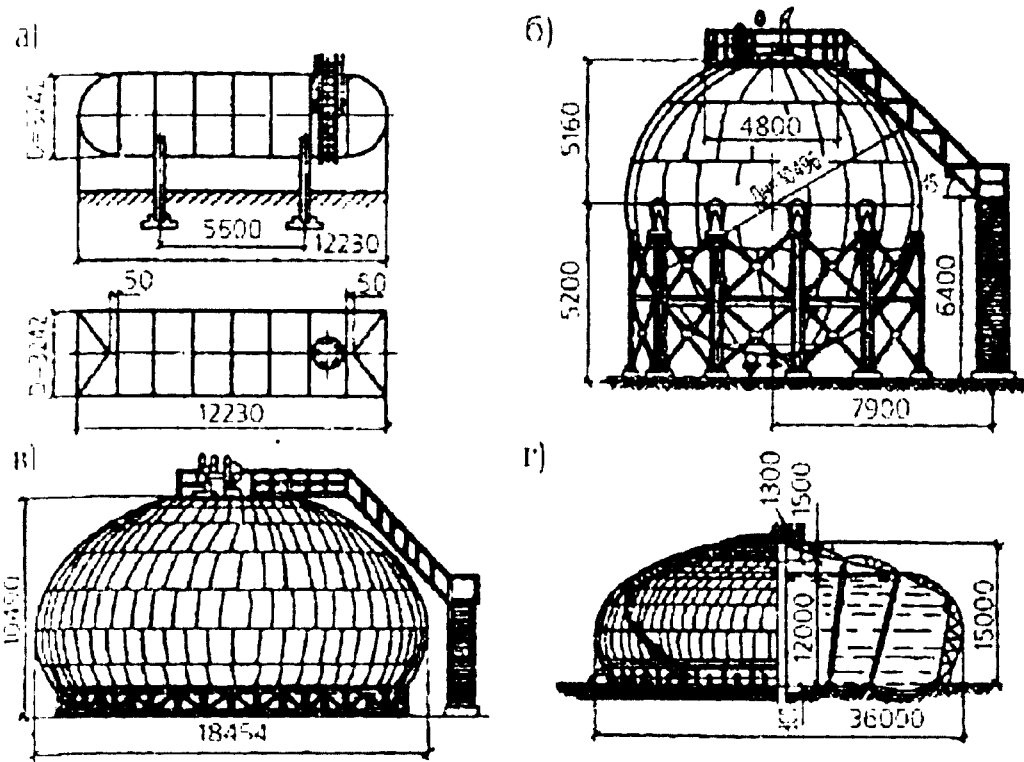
Резервуары повышенного давления: а - горизонтальный цилиндрический; б - шаровой; в - каплевидный; г - многоторовый
